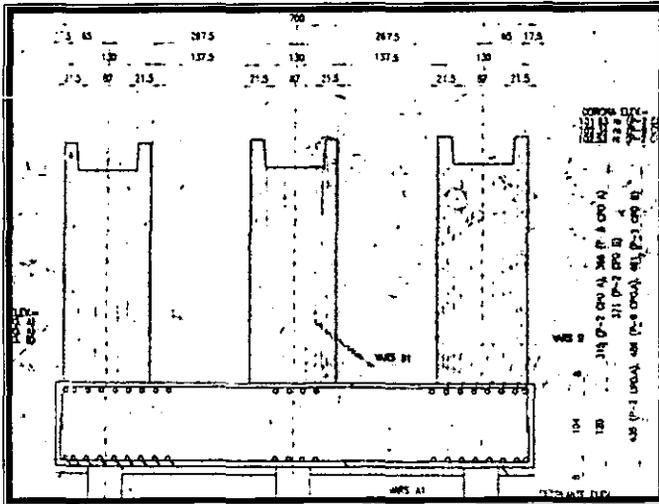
b. Geometría de la pila de sección oblonga. En elevación.
